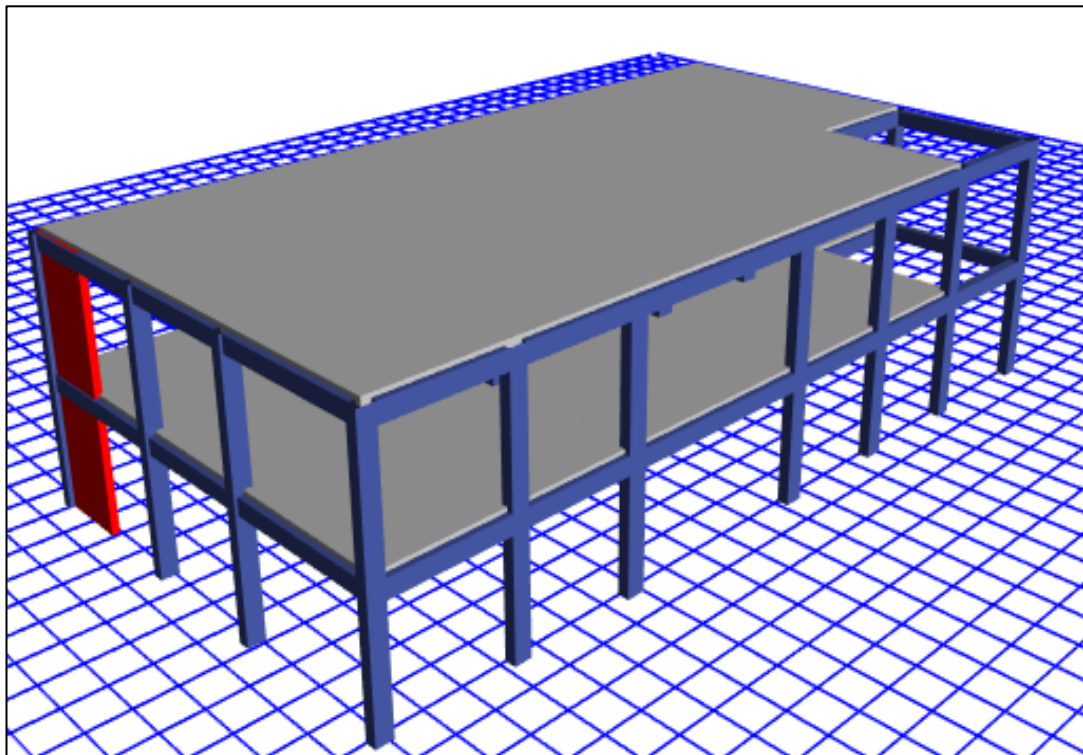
Propuesta de reforzamiento. Fuente: Elaboración propia.
